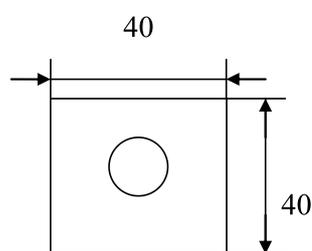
Малое бетонное изделие, армированное полимерной арматурой
